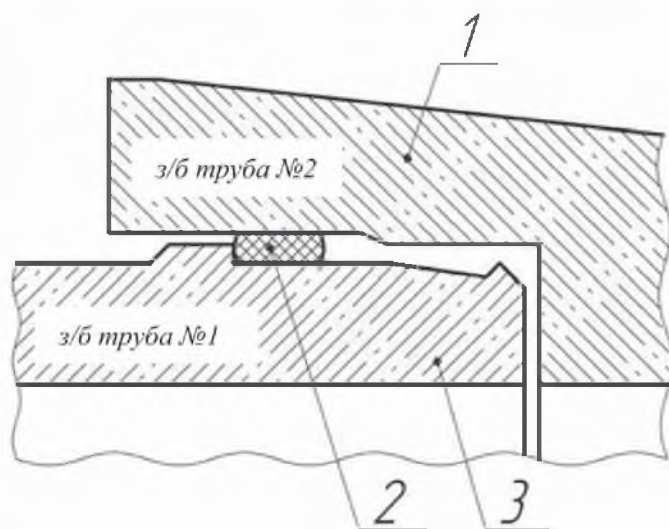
Розтрубне стикове з'єднання залізобетонних напірних віброгідропресованих труб (ГОСТ 12586.0-83):
